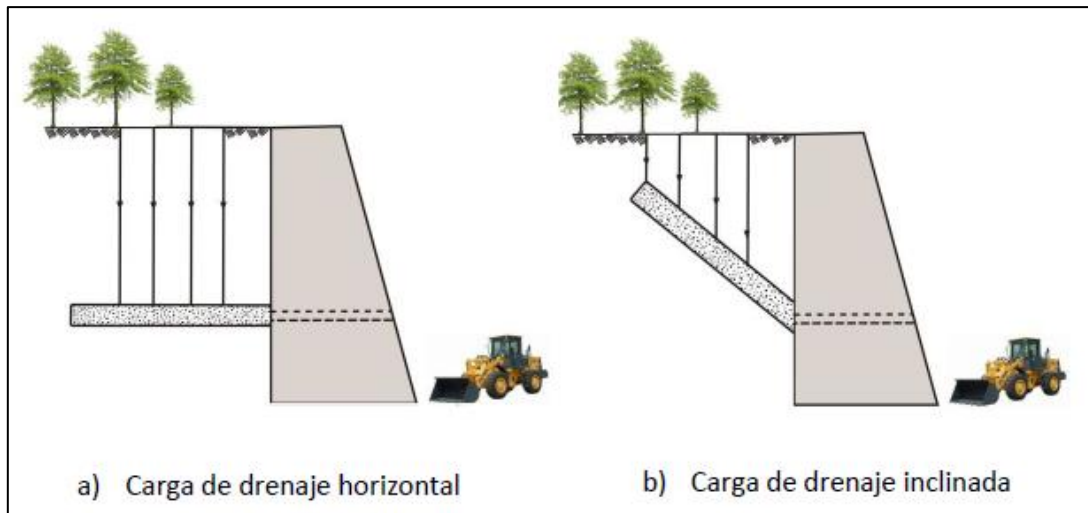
Instalación de capas de drenaje detrás de un muro.
